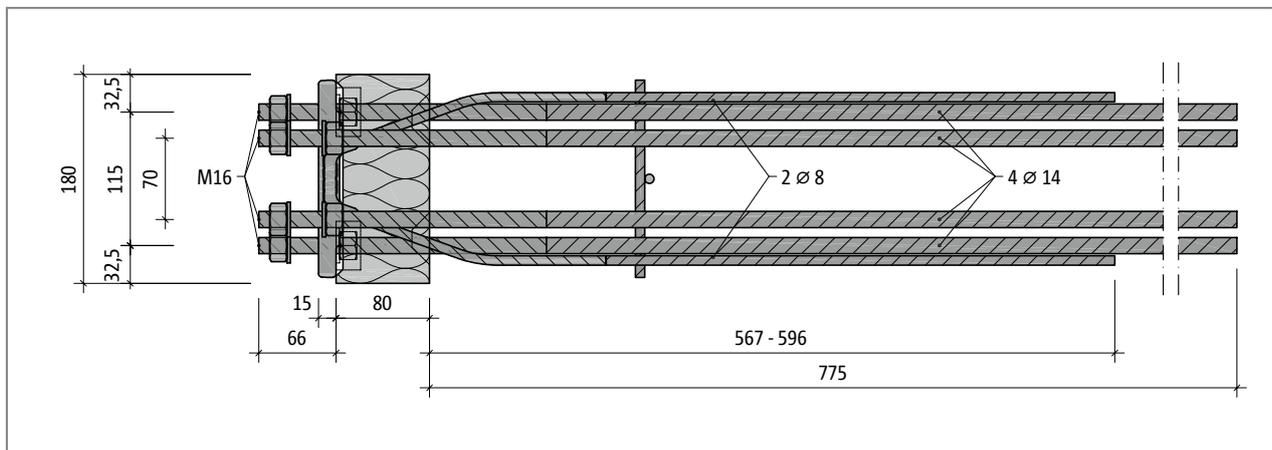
Schöck Isokorb® T Typ SK-MM1-VV1: Grundriss
